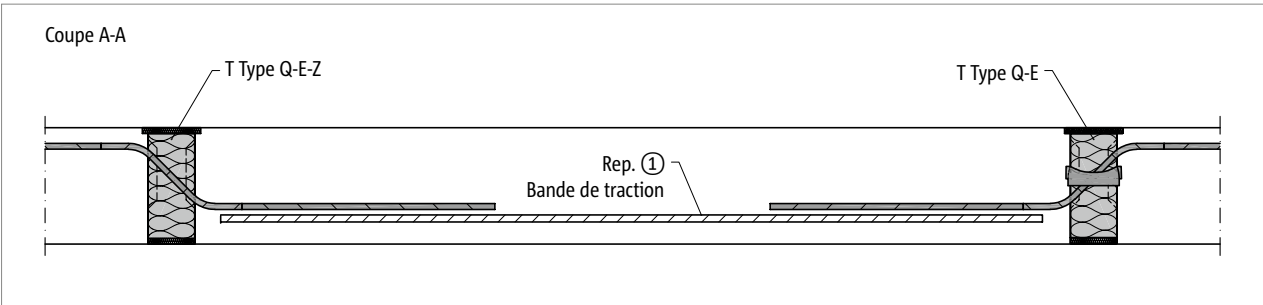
Schöck Isokorb® T Type Q-E, Q-E-Z : Coupe A-A ; application d'une dalle de béton à axe unique
